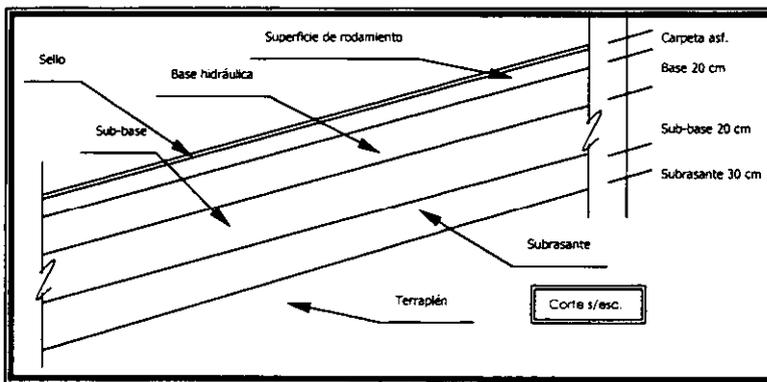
Estructura de pavimento de las rampas de acceso y salida.
